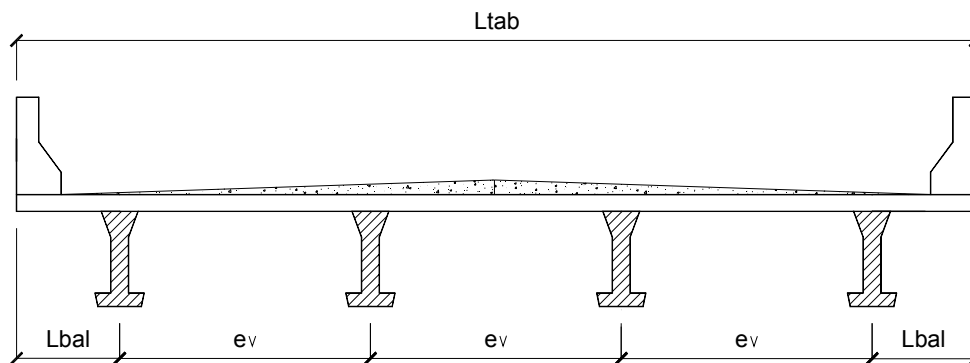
Ilustração do comprimento do balanço na seção transversal
